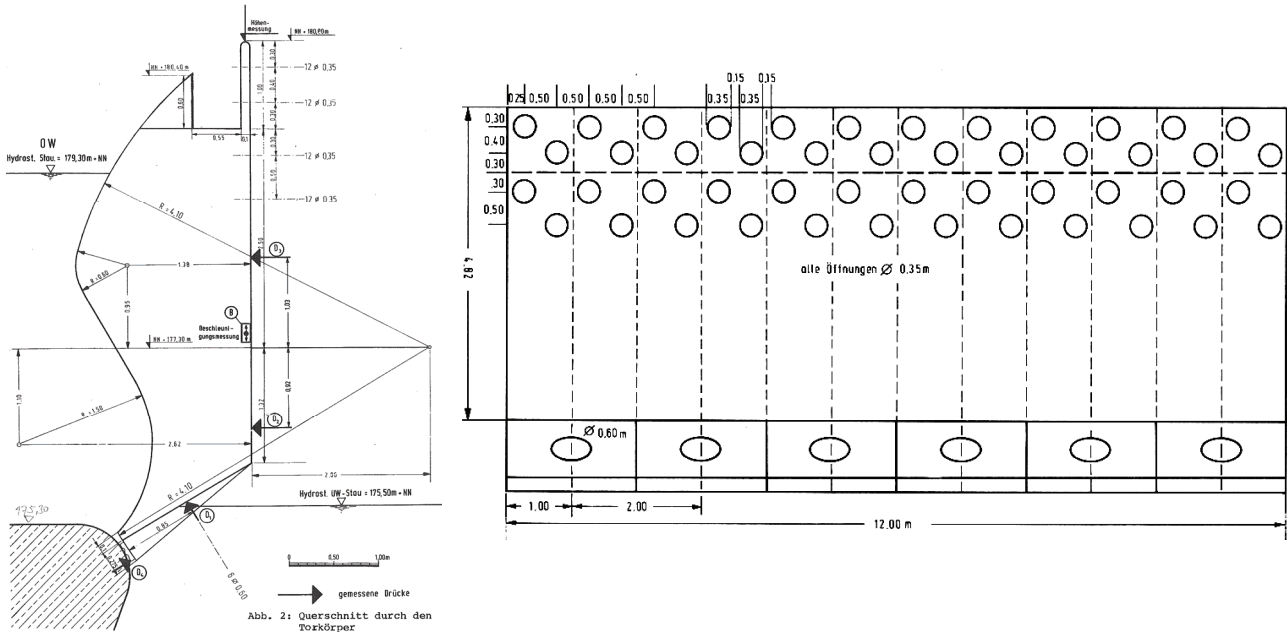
a und b: BAW-Ausführungsvorschlag für Drucksegmenttor, Querschnitt und Rückwand
